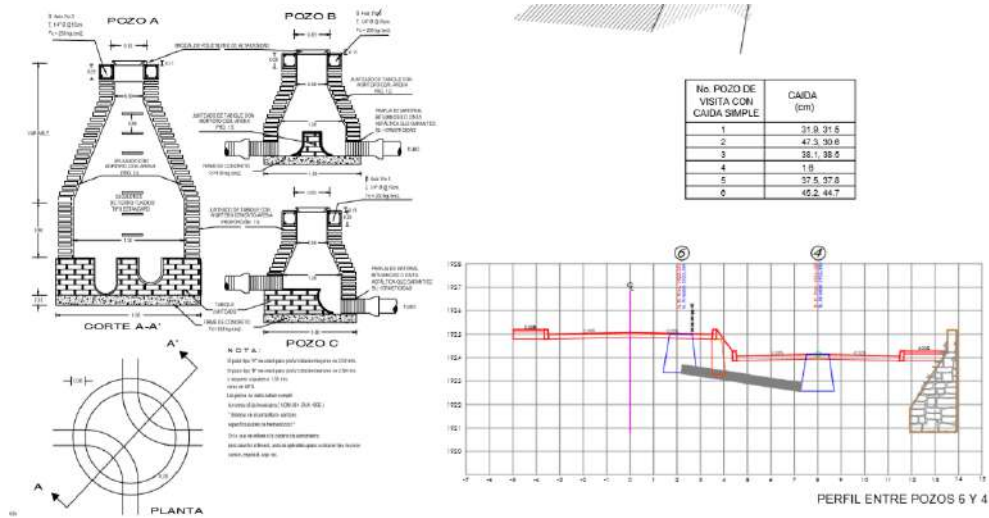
Detalle pozo de visita y perfil entre pozos 6 y 4. Planos de drenaje pluvial de la calle.
